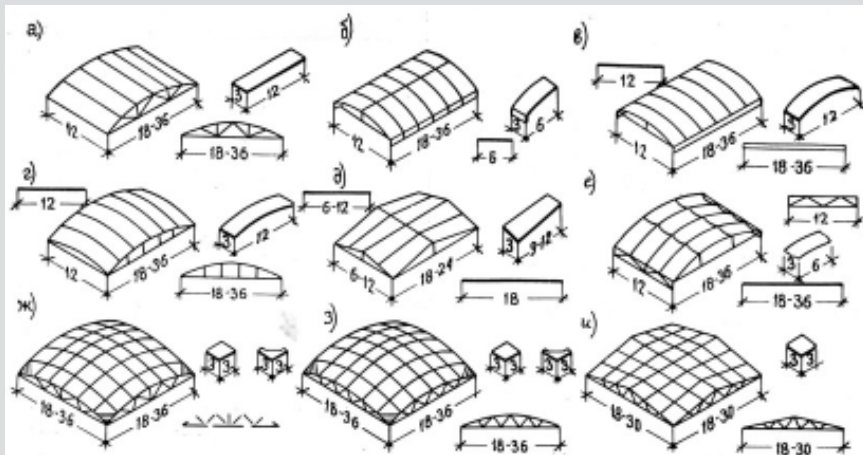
Основные типы сборных железобетонных пространственных конструкций.
